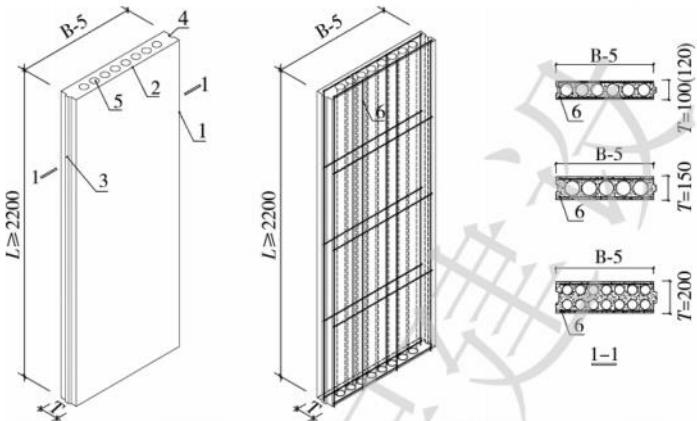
蒸压钢筋陶粒混凝土空心条板构造示意图
